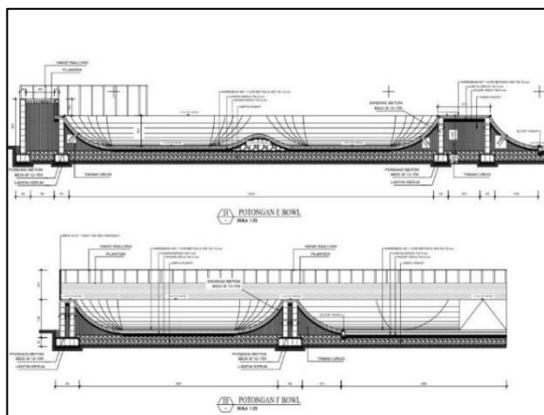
Detail Denah Potongan Skatepark Quarter Ramp 2
